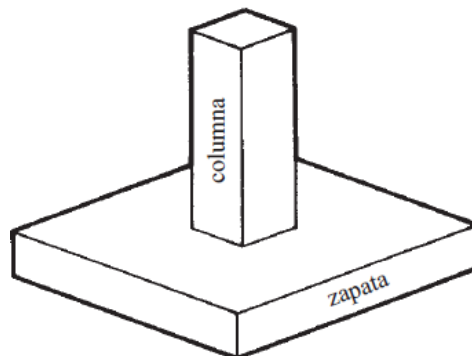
Zapata aislada (McCormac & Brown, 2016).
